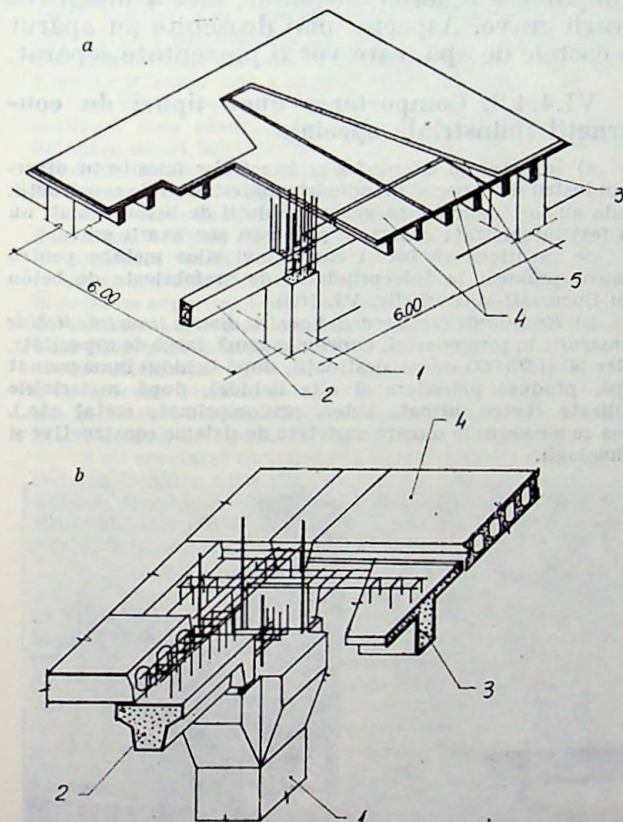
Schema de alcătuire a structurilor combinate de beton armat pentru clădiri industriale etajate: a — cu planșee din elemente II, cu suprabetonare; b — cu planșee din fișii cu goluri: 1 — stîlp monolit; 2 — grindă prefabricată transversală; 3 — grindă prefabricată longitudinală; 4 — element prefabricat de planșeu; 5 — suprabetonare.
